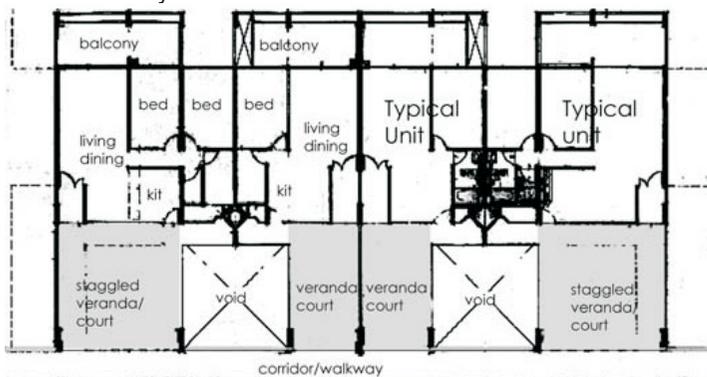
Planta pavimento tipo - Bloco 1
